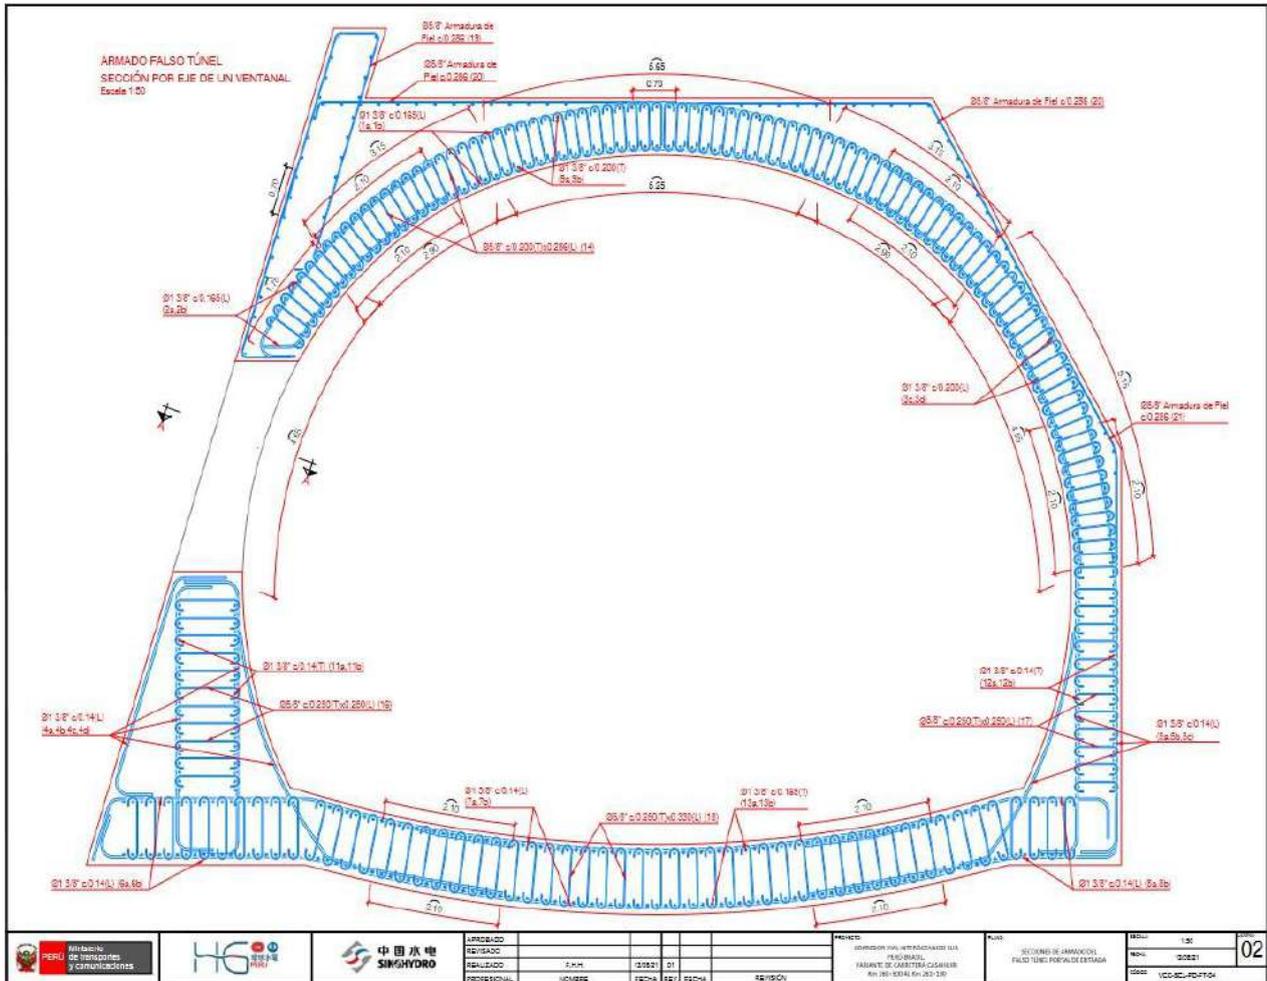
Plano Transversal de la Armadura General del Túnel (Corte Transversal Intermedio)
